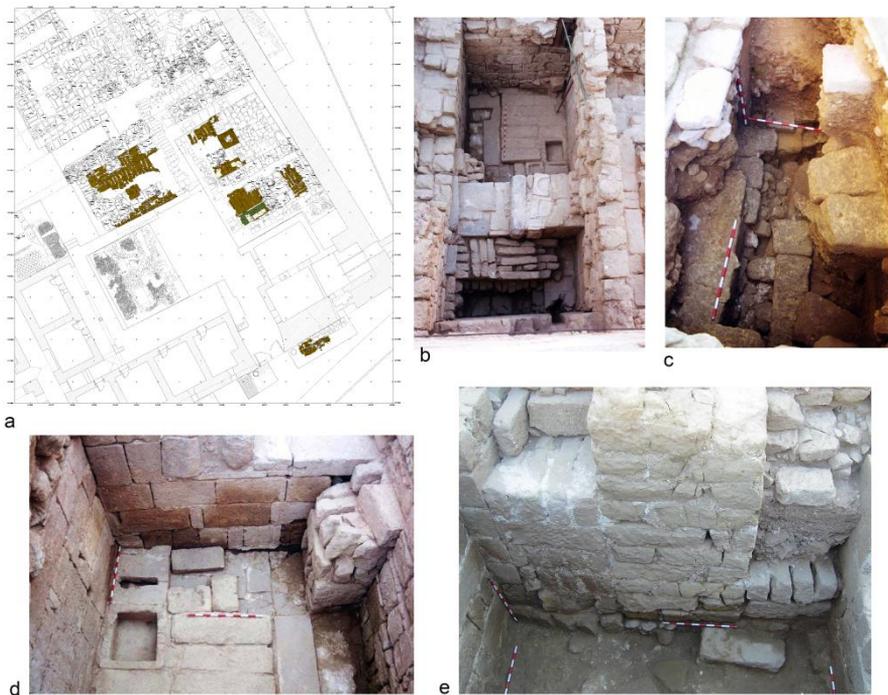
Fase Omeya califaal. a) Planta de las estructuras de esta fase; b) andén perimetral de losas de calcarenita y cimentación de escalera en la zona suroriental del patio; c) estructuras califaales documentadas al sur de la fachada meridional del alcázar; d) detalle de la letrina, pileta y andén perimetral en la zona suroriental del patio; e) cegamiento de los vanos de época califaal
